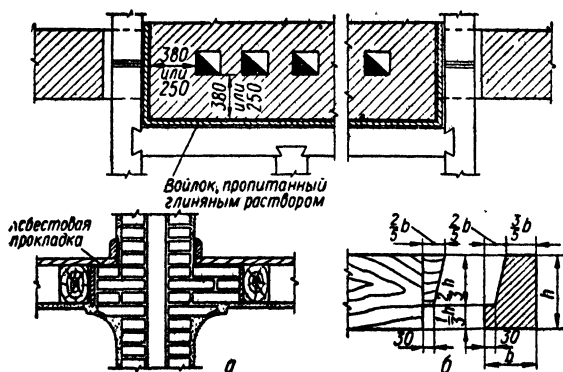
Изоляция деревянных балок у дымоходов (а) и врубка балки в ригель (б).
